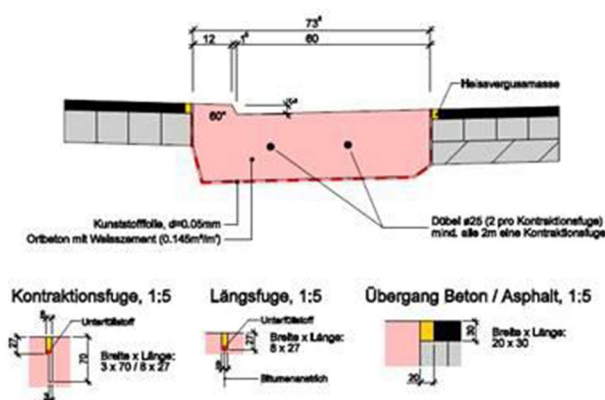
Schemaschnitt Betonband (Quelle Gemeinde Wallisellen)
